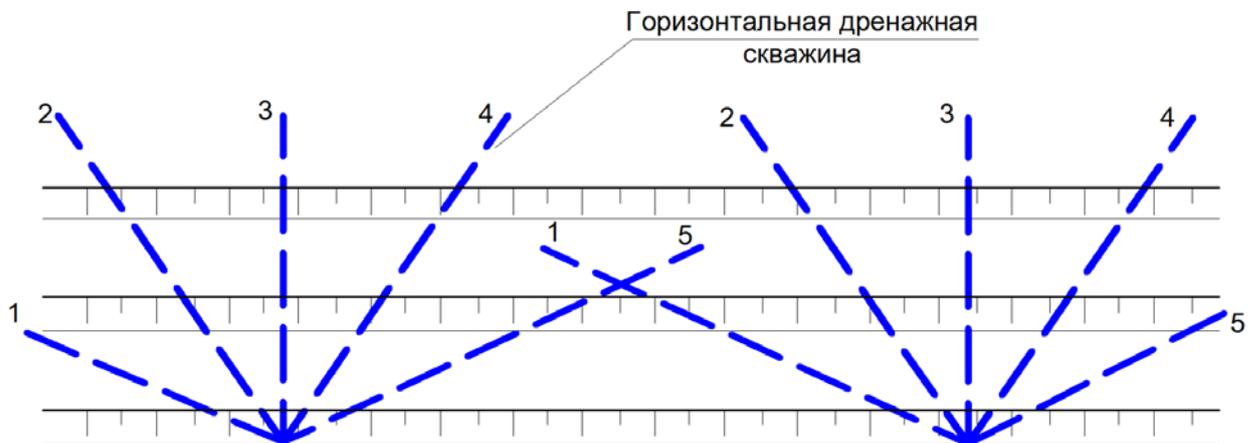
Усовершенствованный вариант способа осушения с узловым расположением горизонтальных дренажных скважин (Схема 2)
